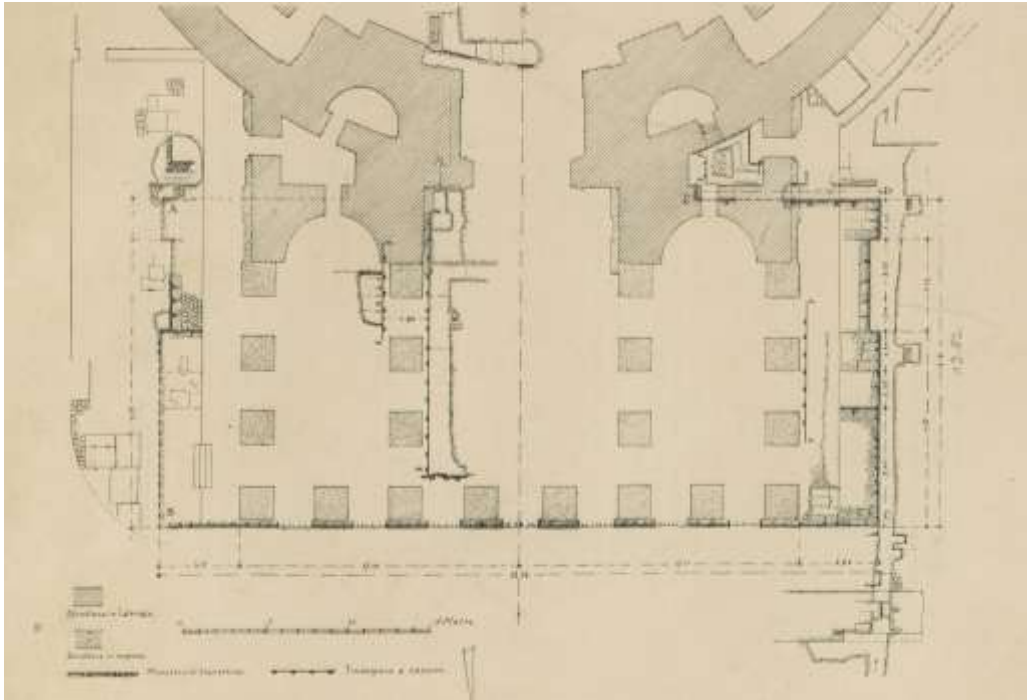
Pianta dell'avancorpo e del pronao - Luca Beltrami 1898 - La pianta mostra gli scavi e i sondaggi effettuati tra il 1892 e il 1893 che individuano il doppio sistema di fondazioni delle colonne del portico.
